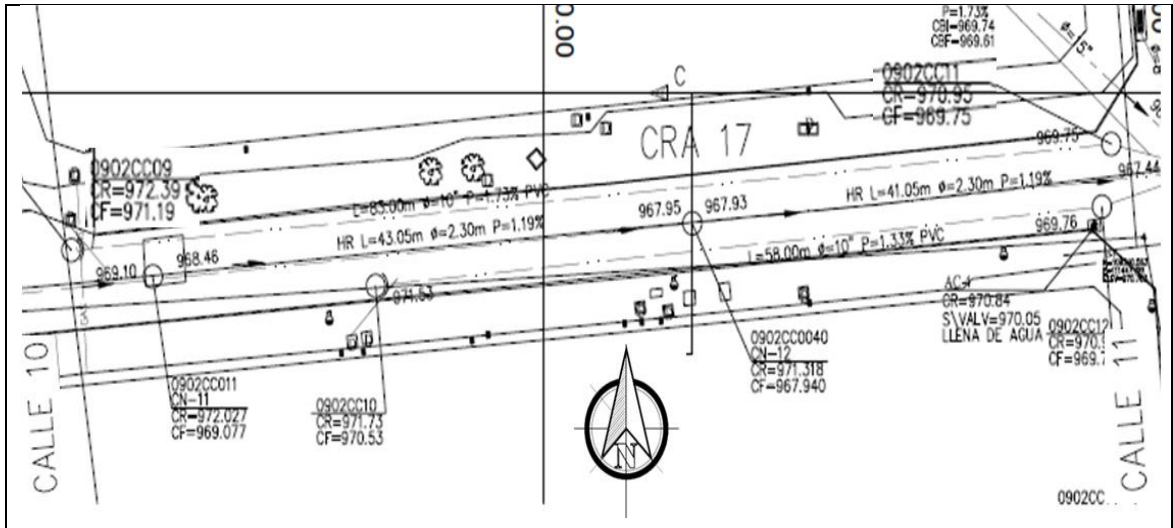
Instalación tubería de 10 carrera 17 entre calle 11 y 10.
